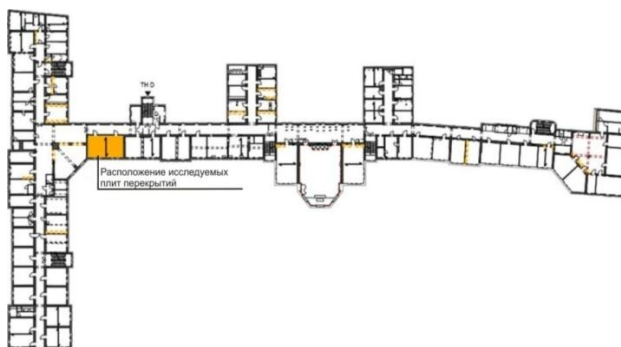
План жилого здания района Шарлоттенбург, Берлин
